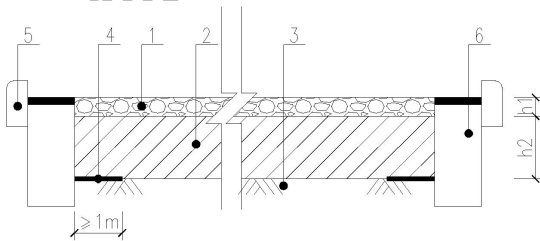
透水水泥混凝土路面排水形式（横断面）
